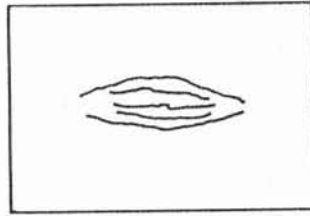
Fissuras na face superior de uma laje provocadas por esforços de flexão-compressão.
